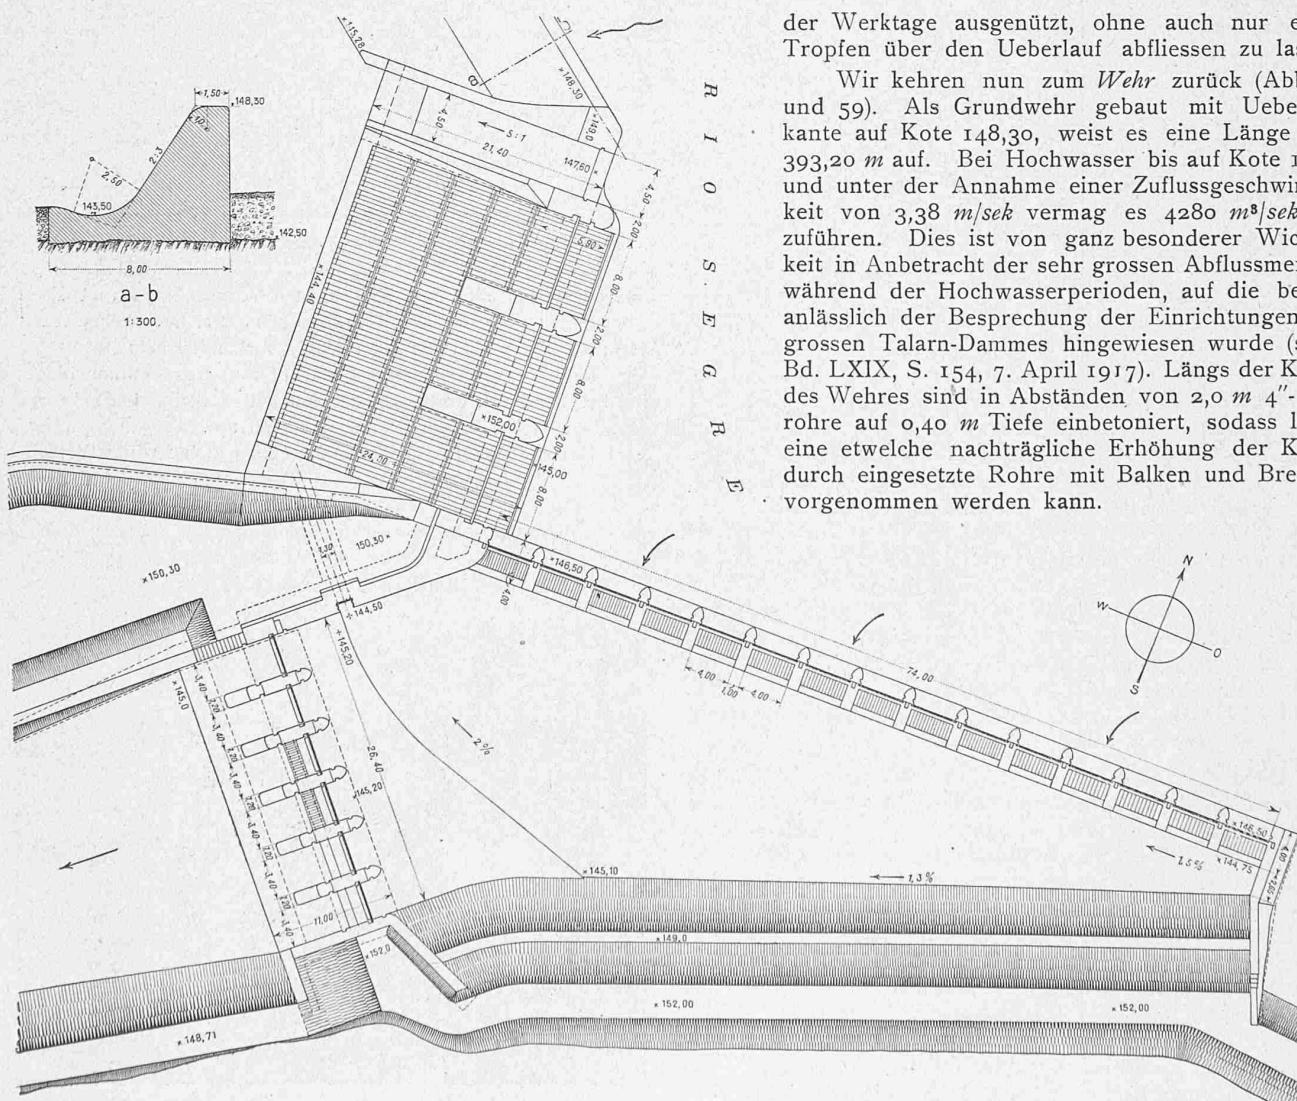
Einlaufbauwerk der Wasserfassung mit Grundablass, Flossgasse und anschliessendem Grundwehr. — 1:600.
